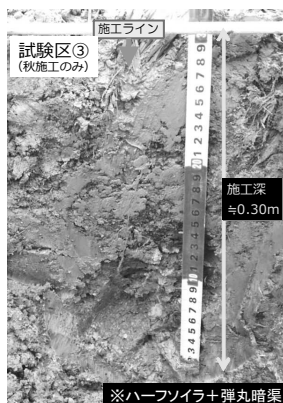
施工1年後の断面 (H28 秋施工 弾丸孔・亀裂確認不可)
